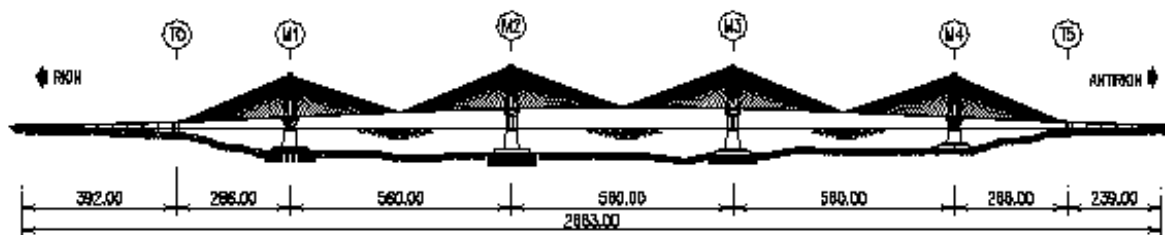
Vista longitudinal del Puente Rion-Antirion.
